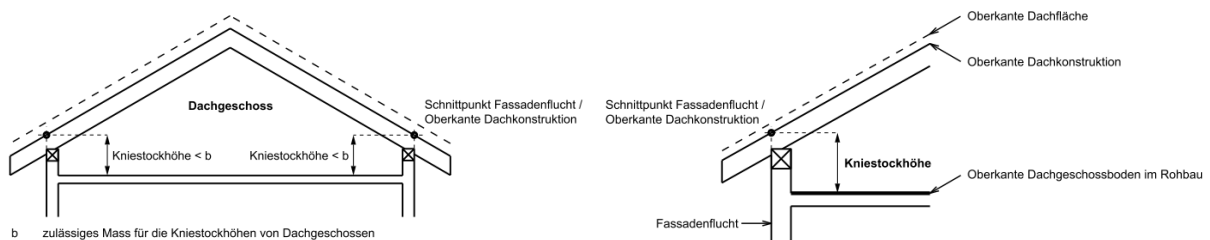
Figur 6.3 Dachgeschoss und 5.3 Kniestock, IVHB
